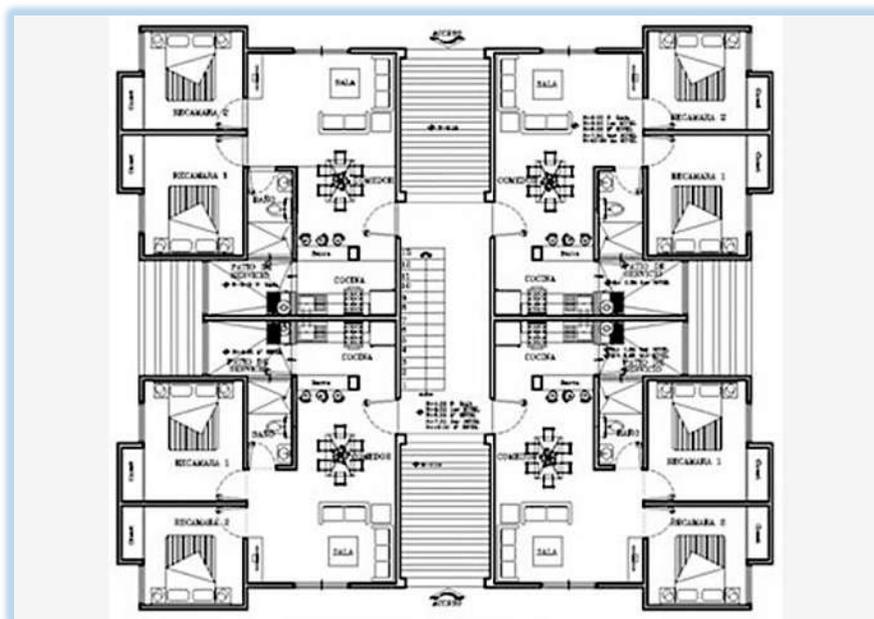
Planta arquitectónica. Fuente: Upani Inmobiliaria (2008).
